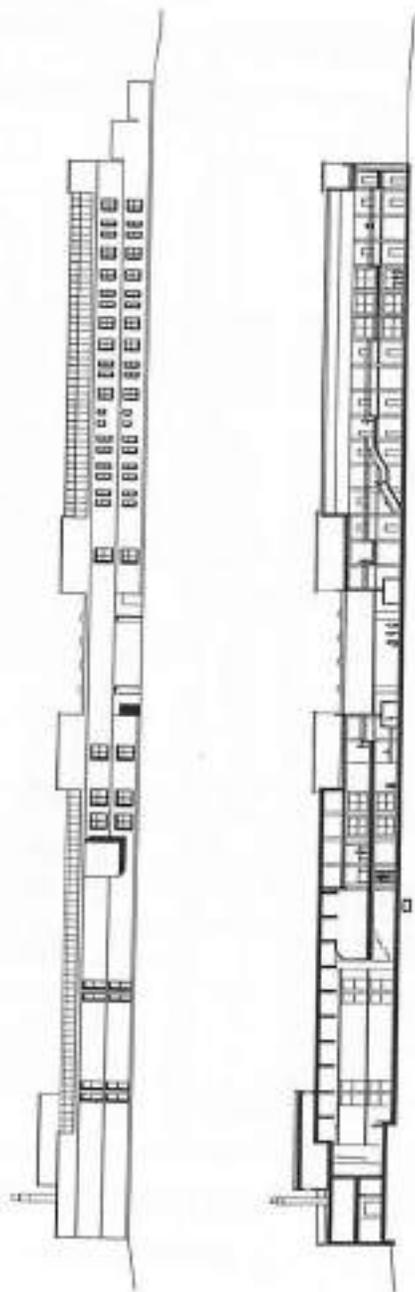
Centro di formazione e cultura a Modena: prospetto e sezione longitudinale.
